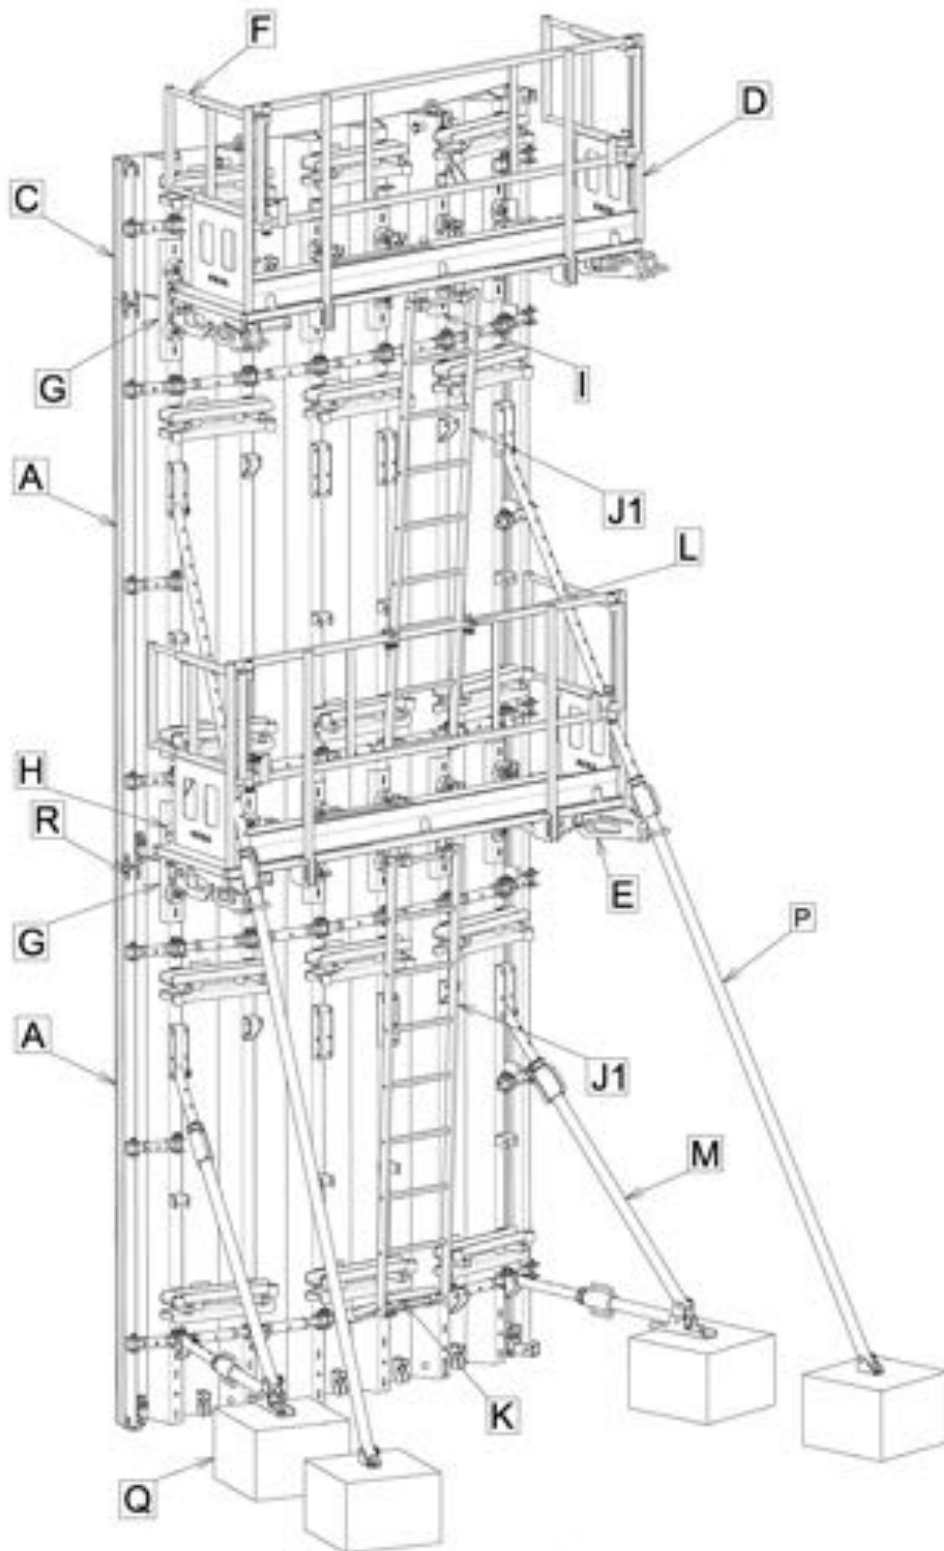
Assemblage de deux banches de 280 avec une réhausse de 70
